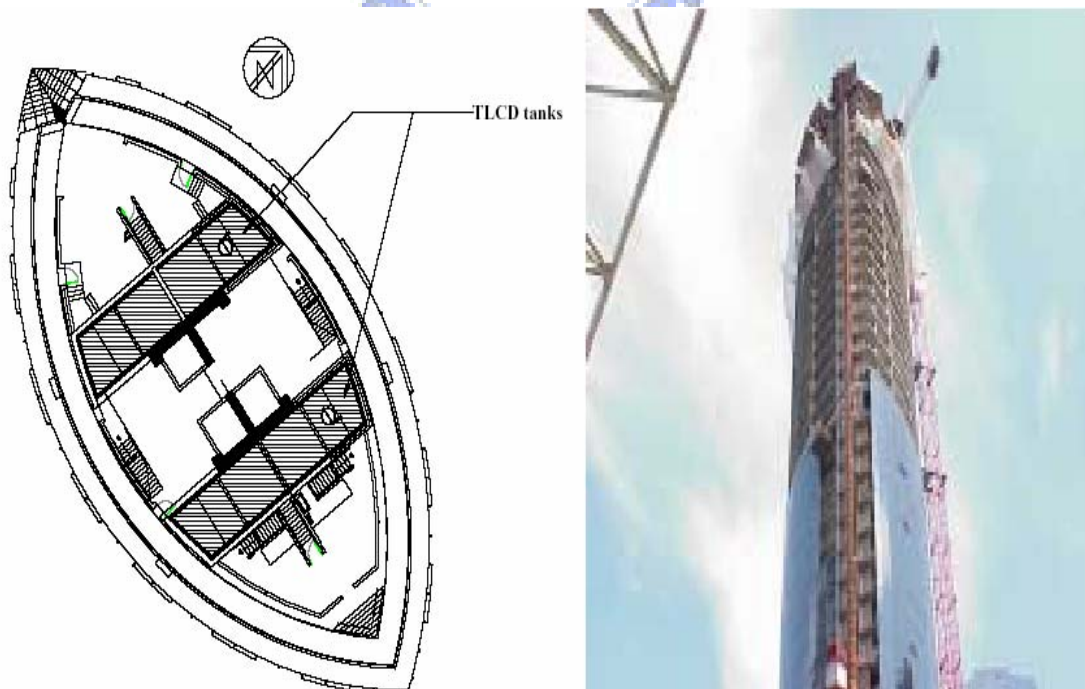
TLCD 系統於加拿大 Wall center 之減振應用
